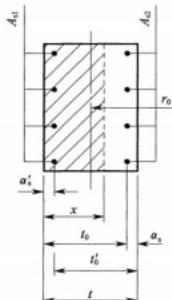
井壁偏心受压承载力和钢筋配置计算简图
